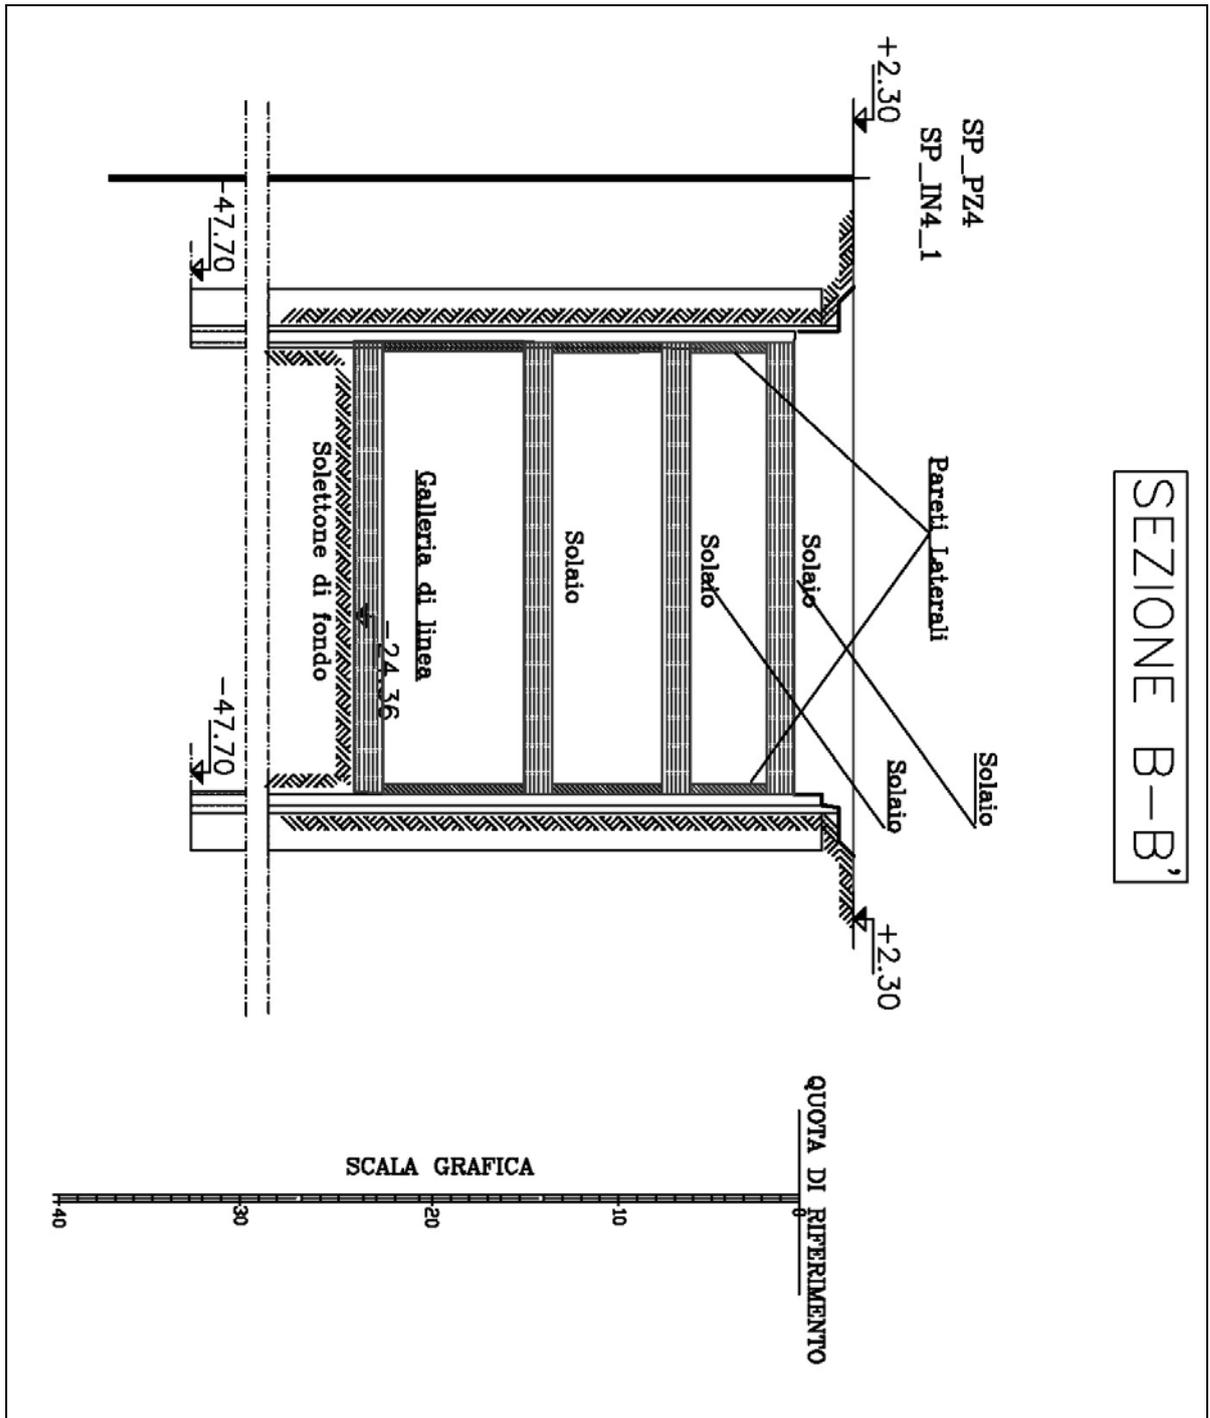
Sezione B-B' pozzo stazione, raffigurante la suddivisione in aree di lavoro.
